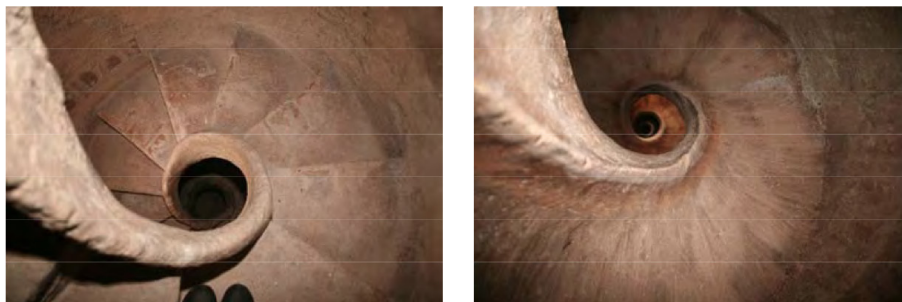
5.58. Escalera de caracol. Vista aérea y vista cenital.
